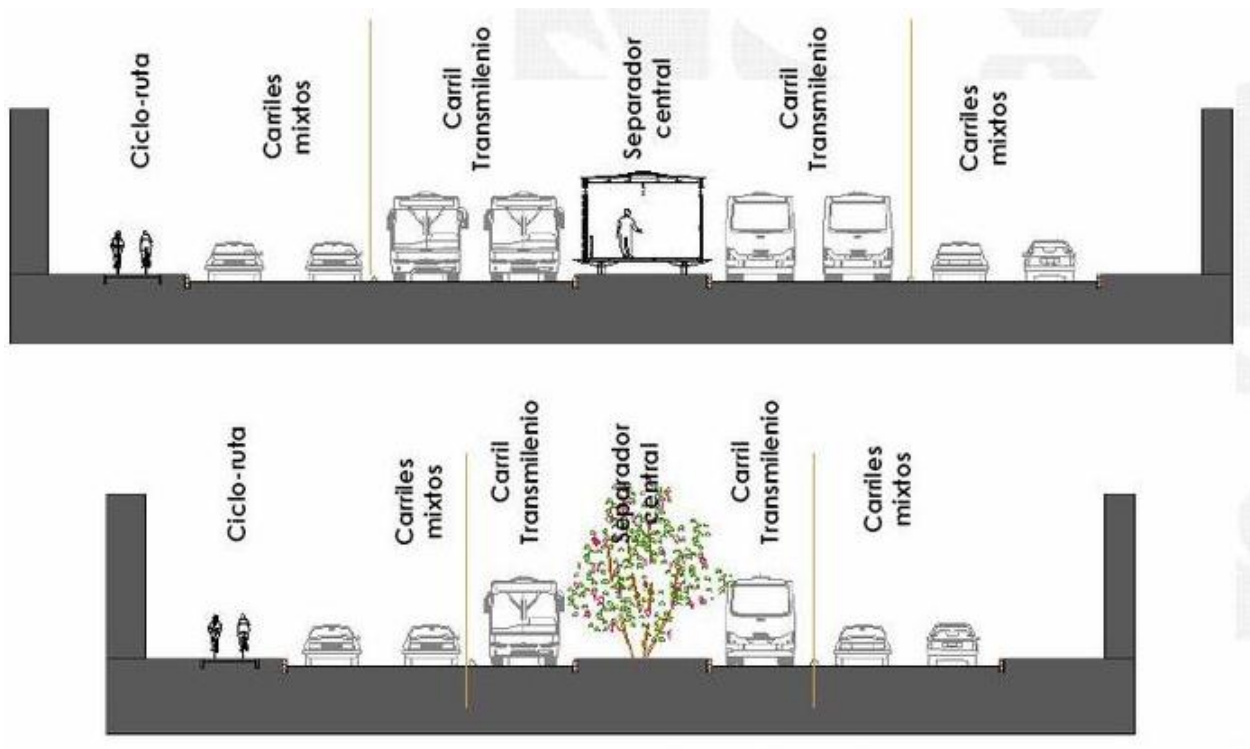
Sección Transversal. Carera 3 entre calle 26 y av. 19. (Skycrapercity, Infraestructura de Transporte)
